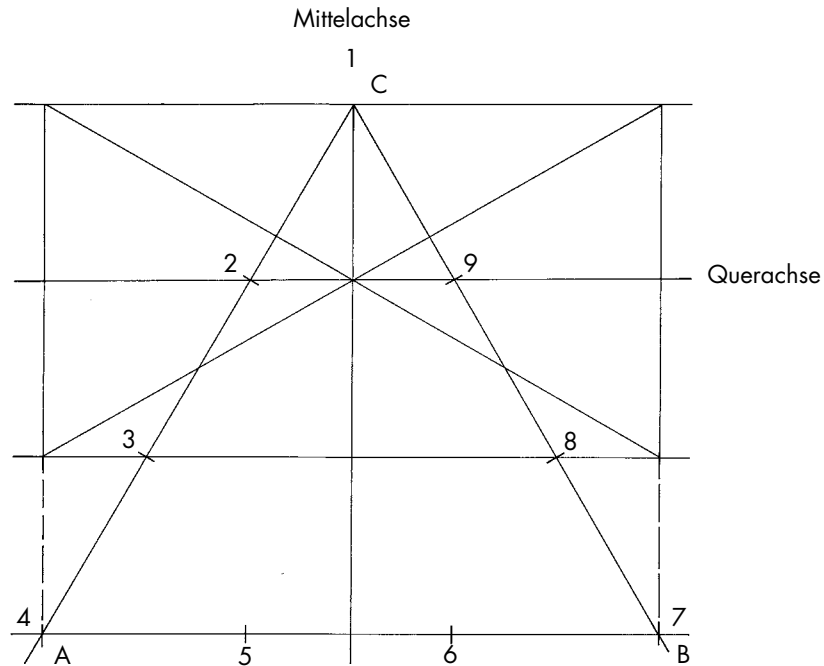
b Oberüttfeld, Grundrißentwurf. Variante I, Stufe II. M. 1:250.
